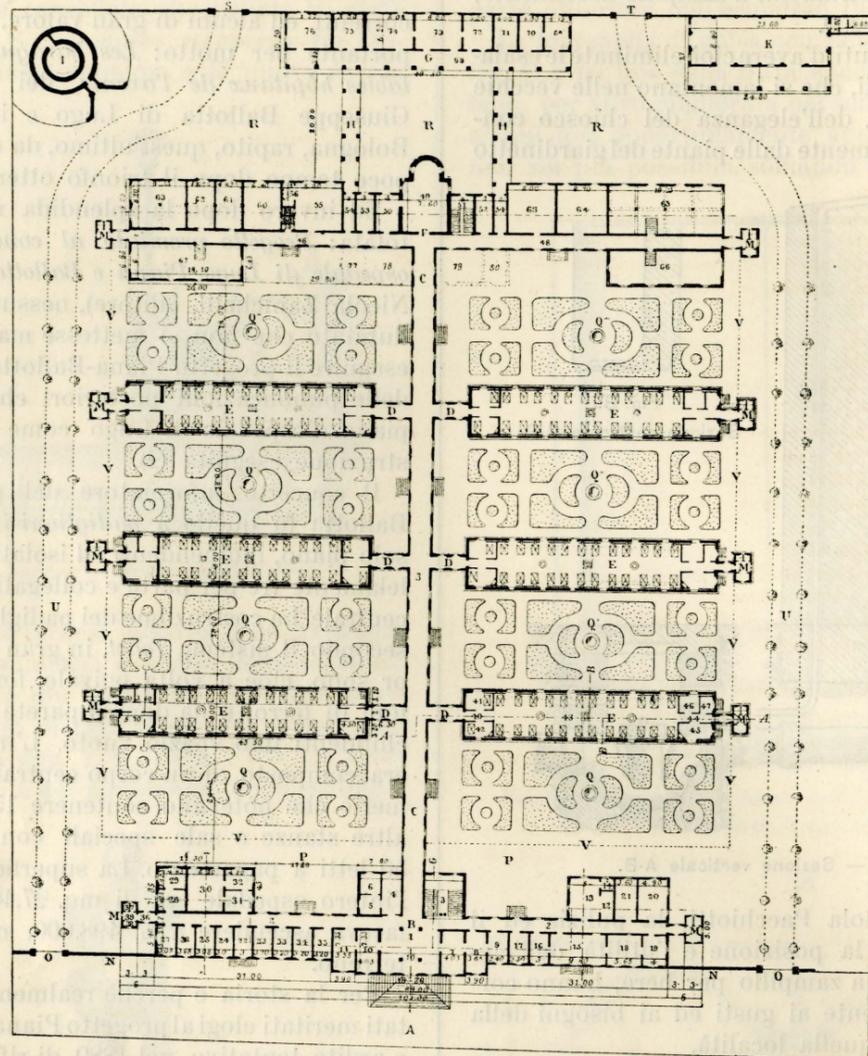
Planimetria generale del progetto premiato e non eseguito Piana-Ballotta (Scala 1:1250).
